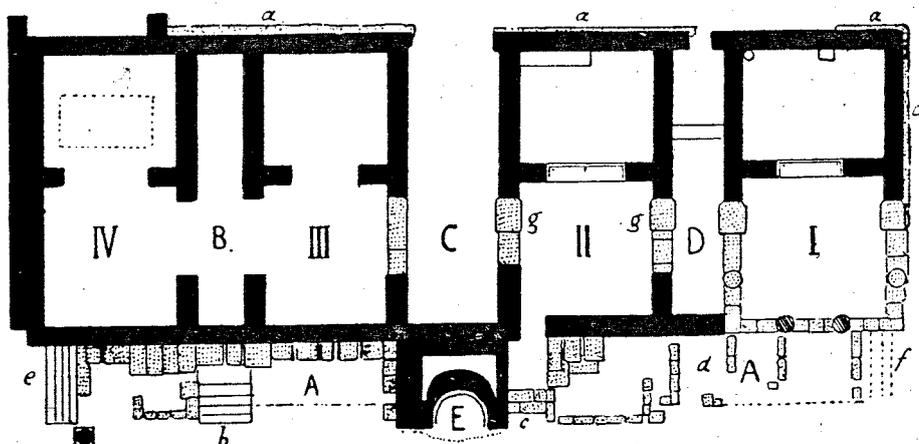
Pianta dei «quattro Tempietti» (Scavi 1885-86).
